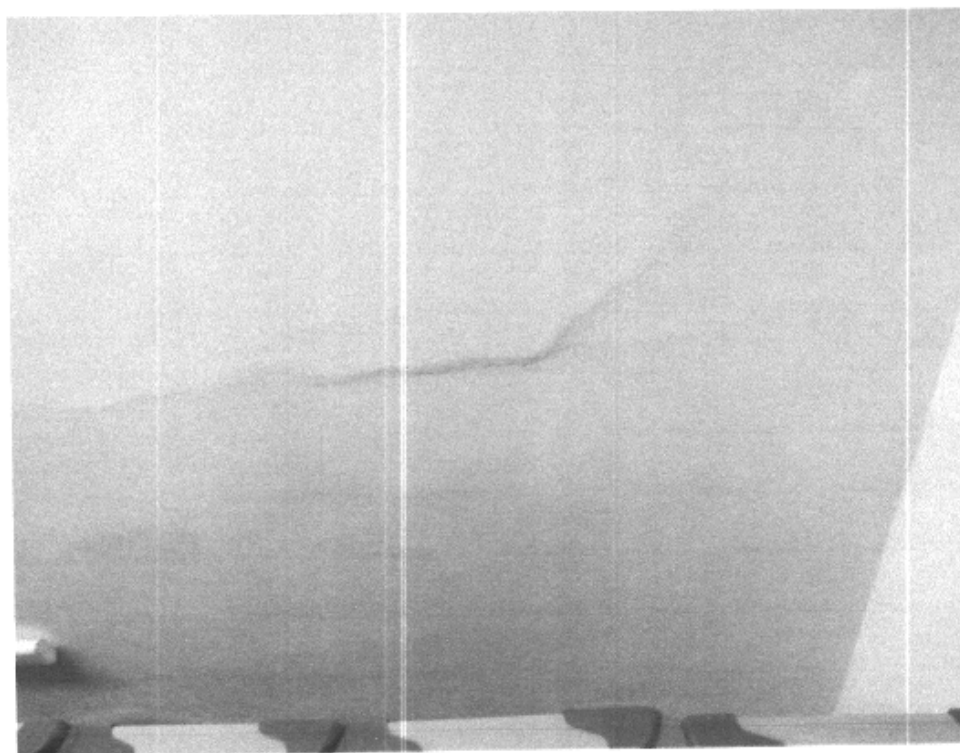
Fissura na laje, vista de sala do piso inferior
